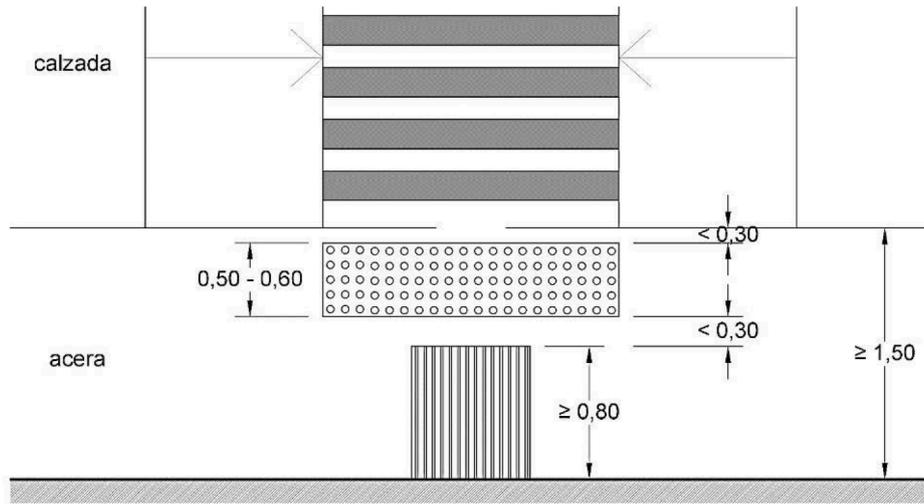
10. Ejemplo de cruce entre acera y calzada elevada
